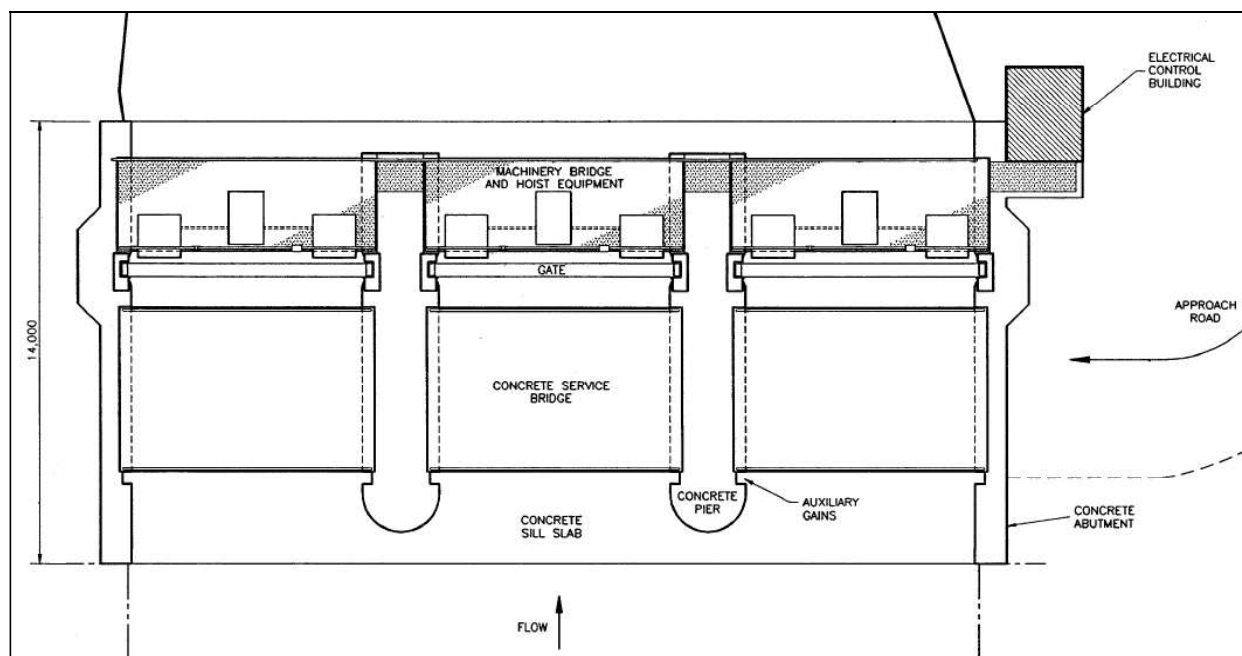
Disposition générale du barrage de Portage, vue d'en haut, Vanne n° 1 à droite.
